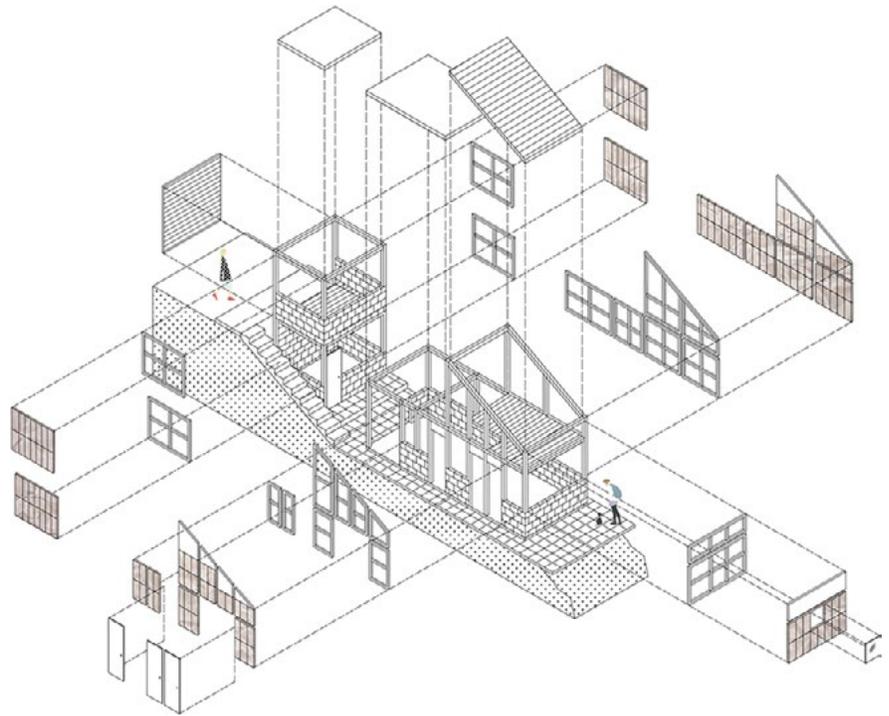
Despiece constructivo para la casa de la familia Domínguez aplicando las placas cerámicas adaptadas (fuente: Elaboración propia, 2018).
